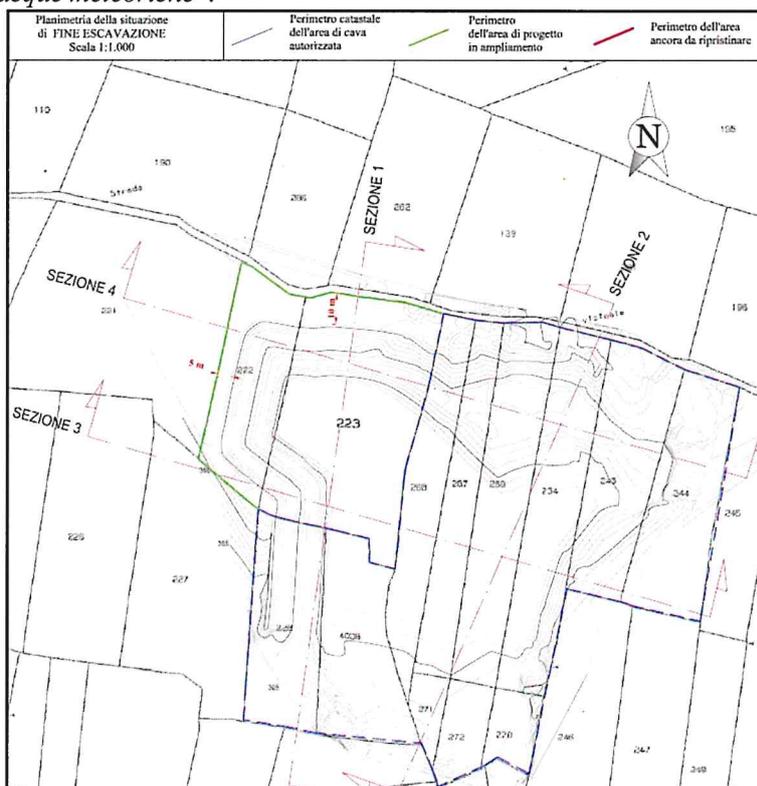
Planimetria dell’area di cava a fine escavazione (da elaborato “Tavola 1_Progetto escavazione” allegato allo SPA).
